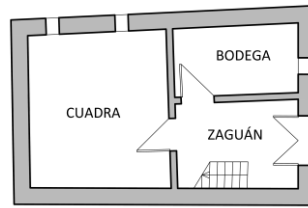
Ejemplo de distribución interior de planta baja en vivienda serrana (elaboración propia).
